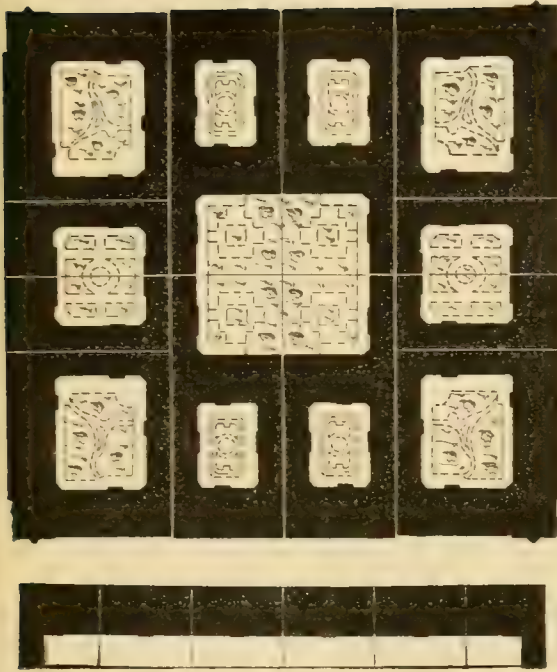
Lageplan. Entwurf zur Bebauung des Weisbach'schen Geländes zu Berlin.
